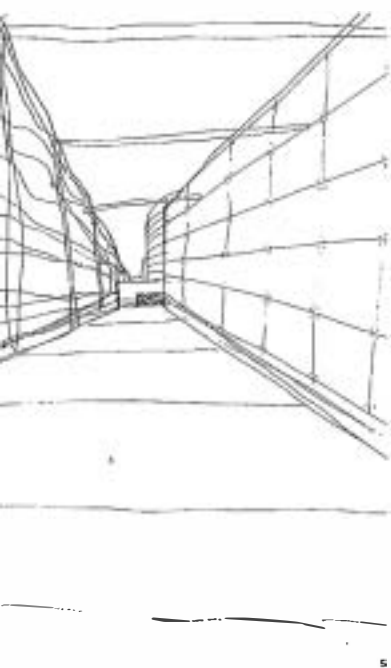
Pavilhão do Futuro (pormenor da fachada).
